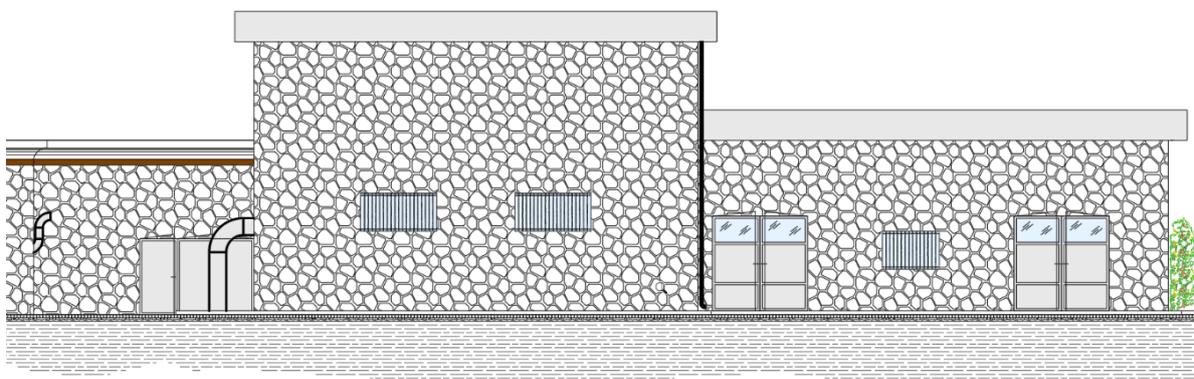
Prospetto ovest del nuovo impianto di Brancolino.
